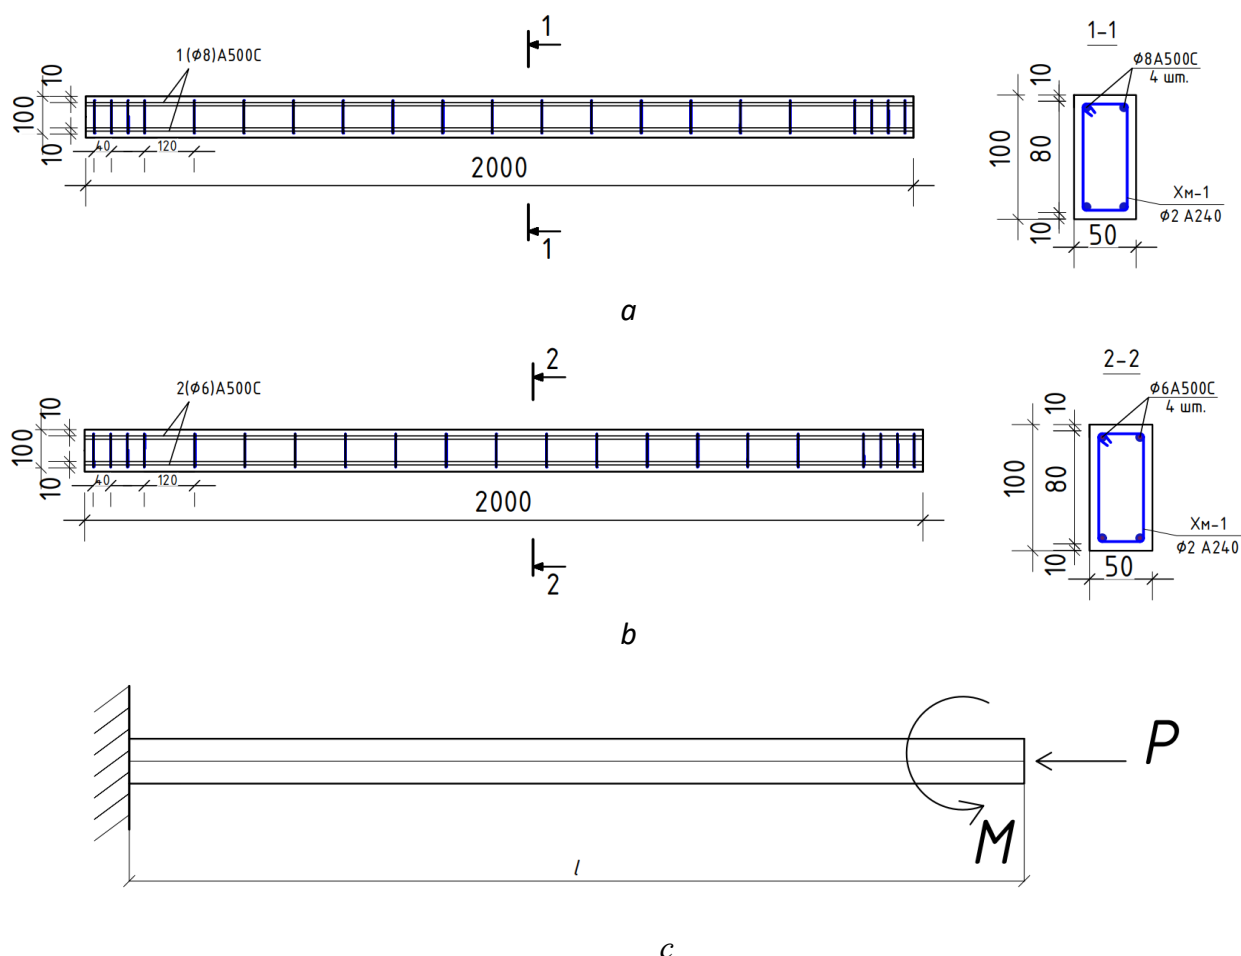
Схема армирования железобетонных колонн (а, б) и их расчетная схема (с)
